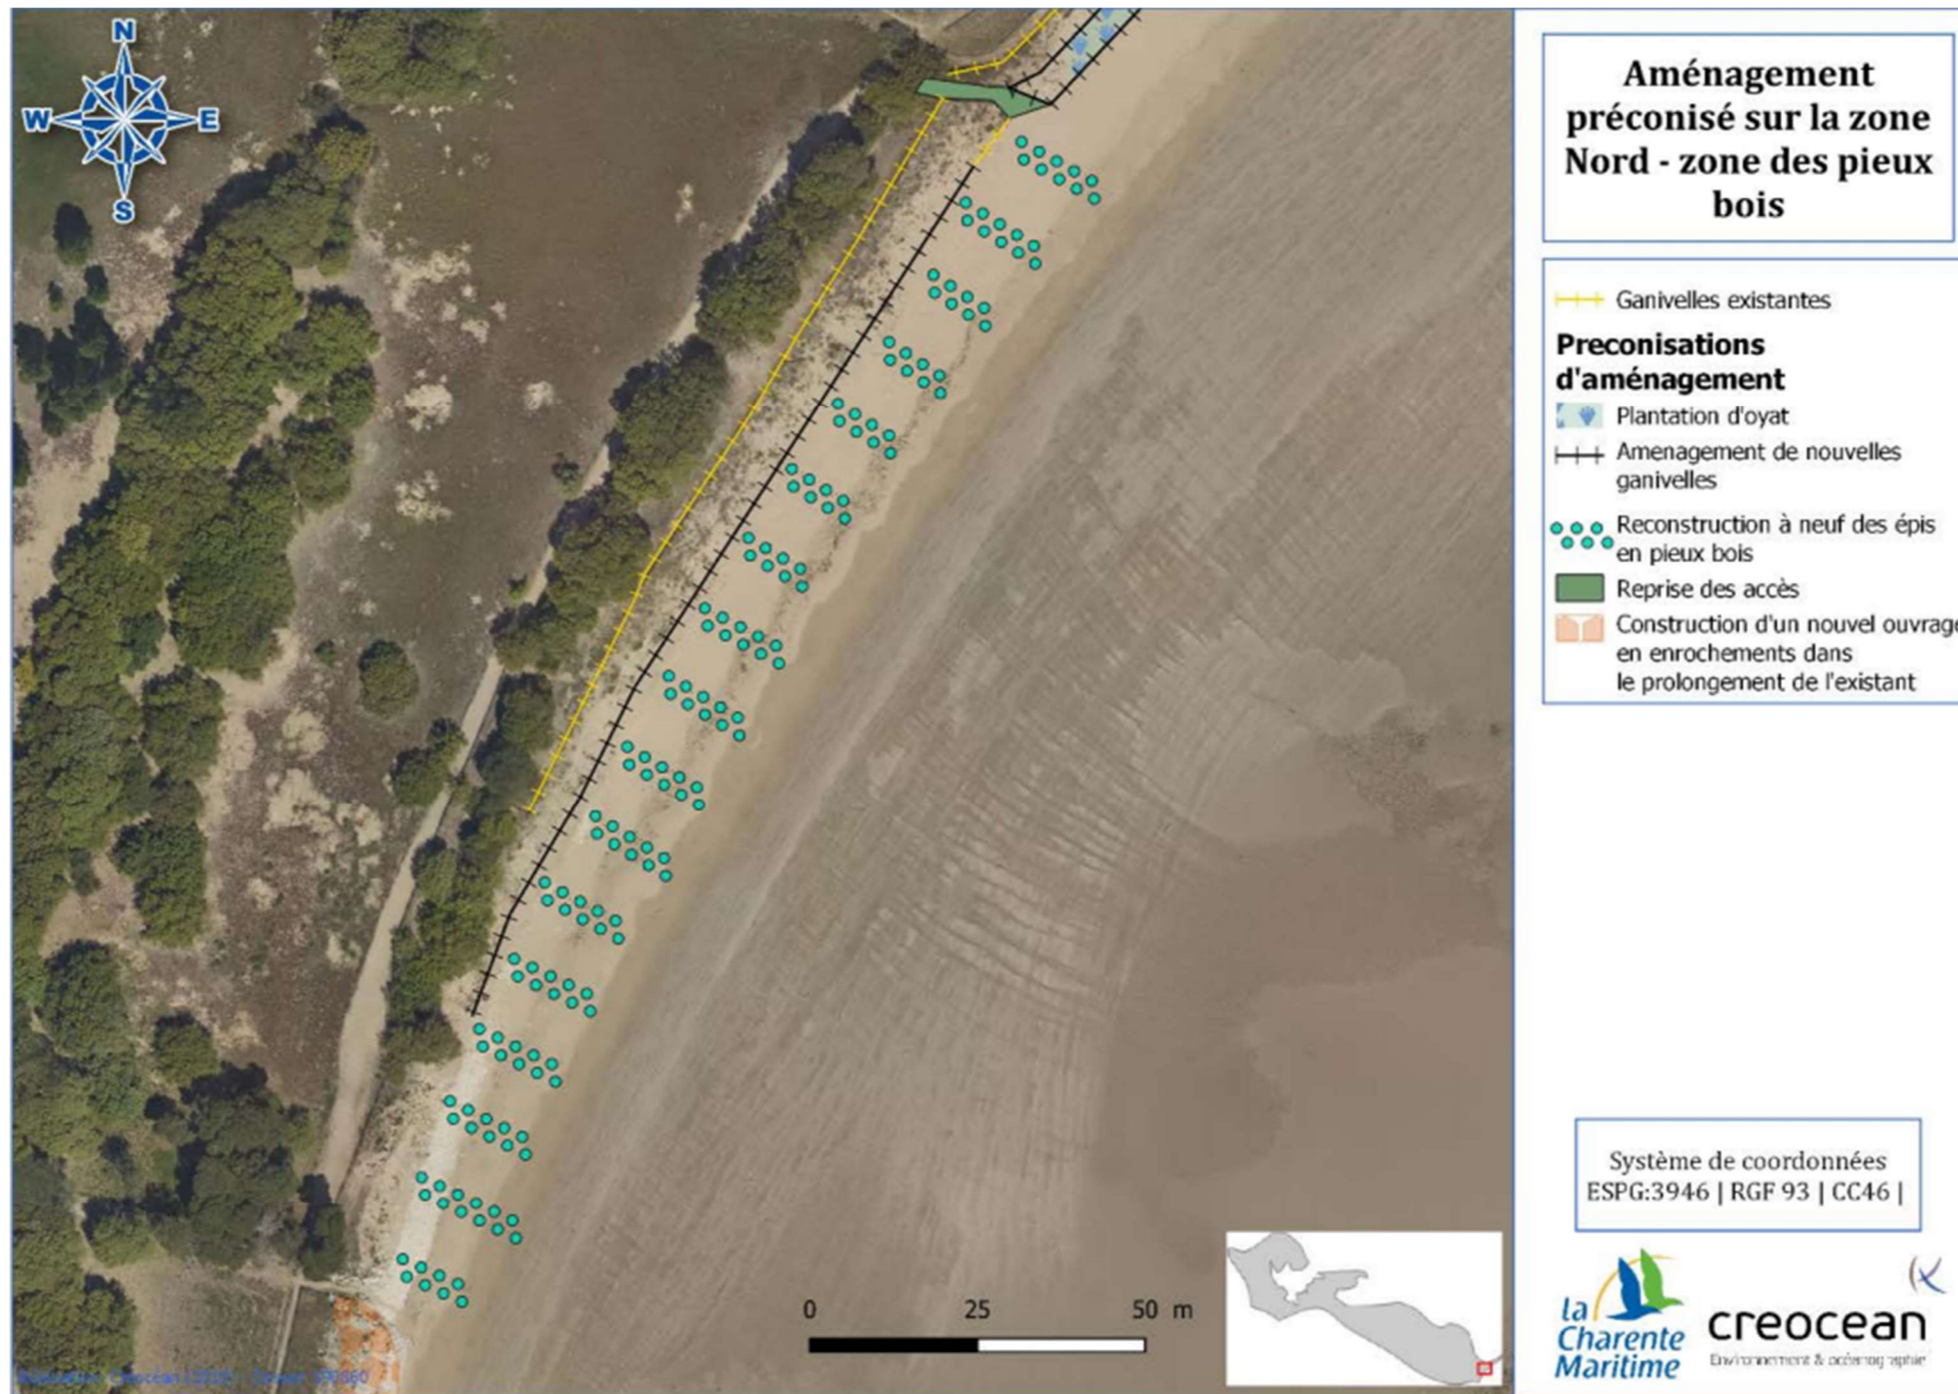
Plan d'aménagement – épis en pieux bois – du projet « 3. Système de protection de côte du virage du défend »
